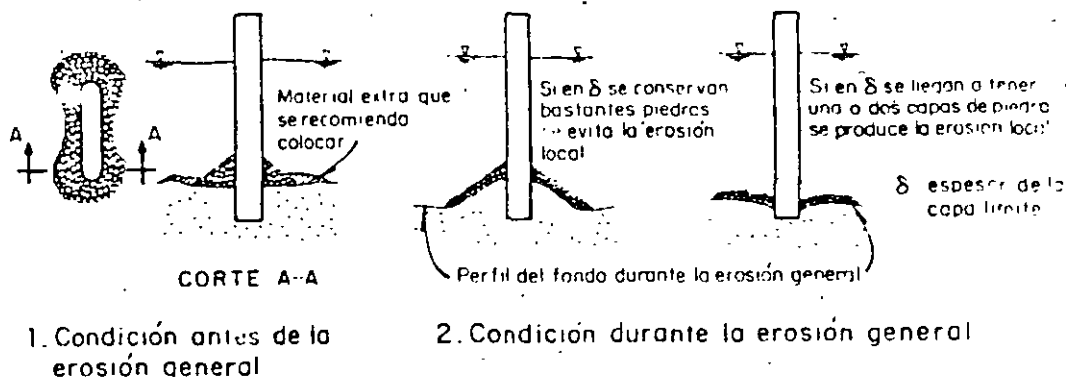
Comportamiento de un pedraplén que ha sido colocado sobre el fondo actual, con el fin de proteger la pila
